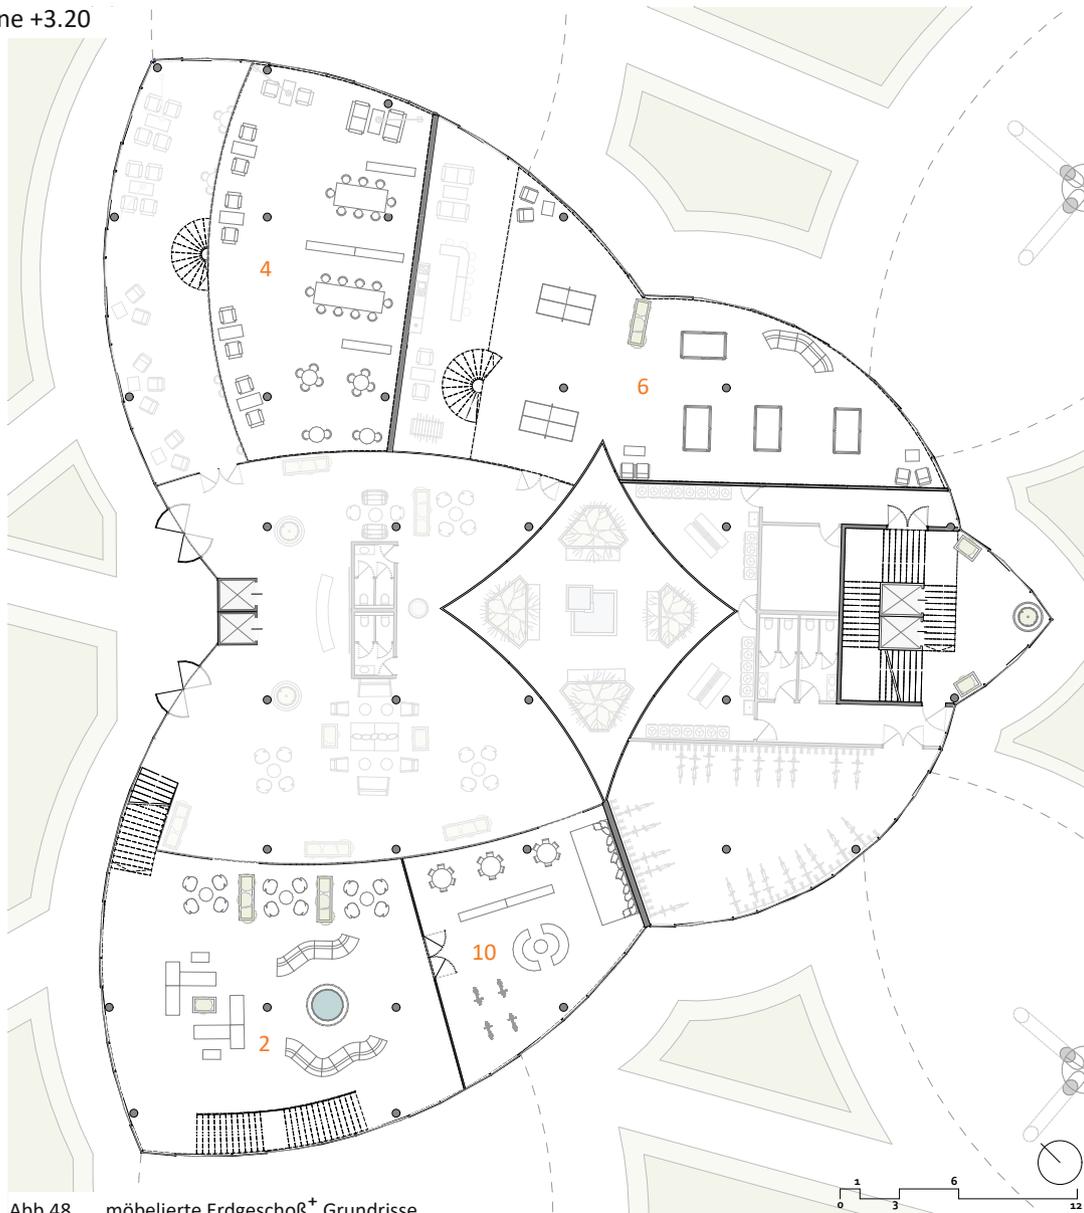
möblierte Erdgeschoß⁺ Grundrisse
